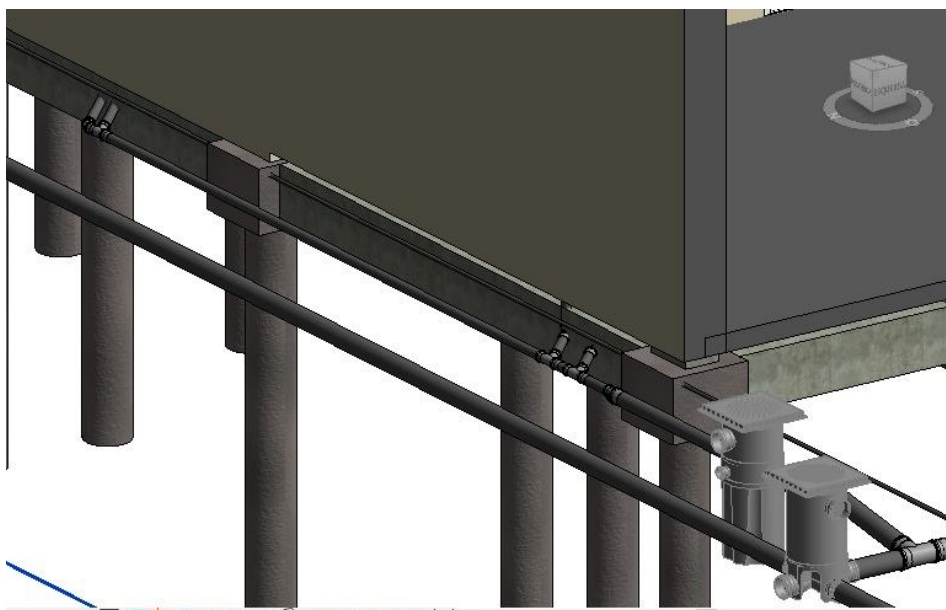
Foto da interferência encontrada entre estrutura e as instalações hidro sanitárias (Fonte: Próprio autor).
